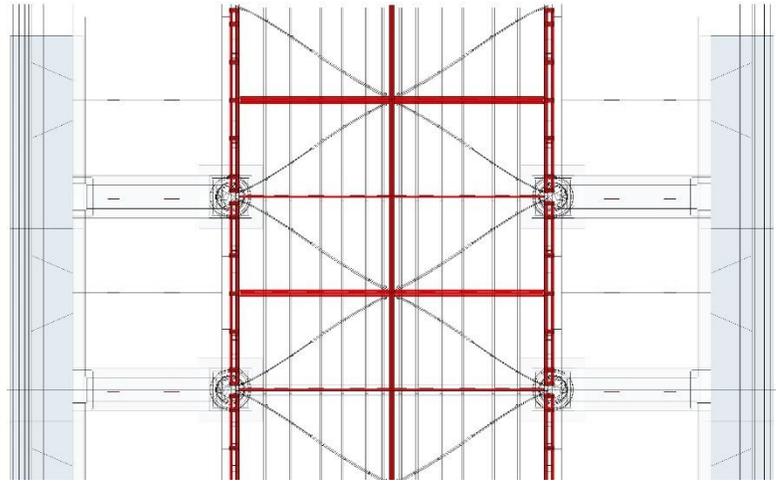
Planta esquemática de nave y estructura metálica identificada en rojo. Elab. propia.
